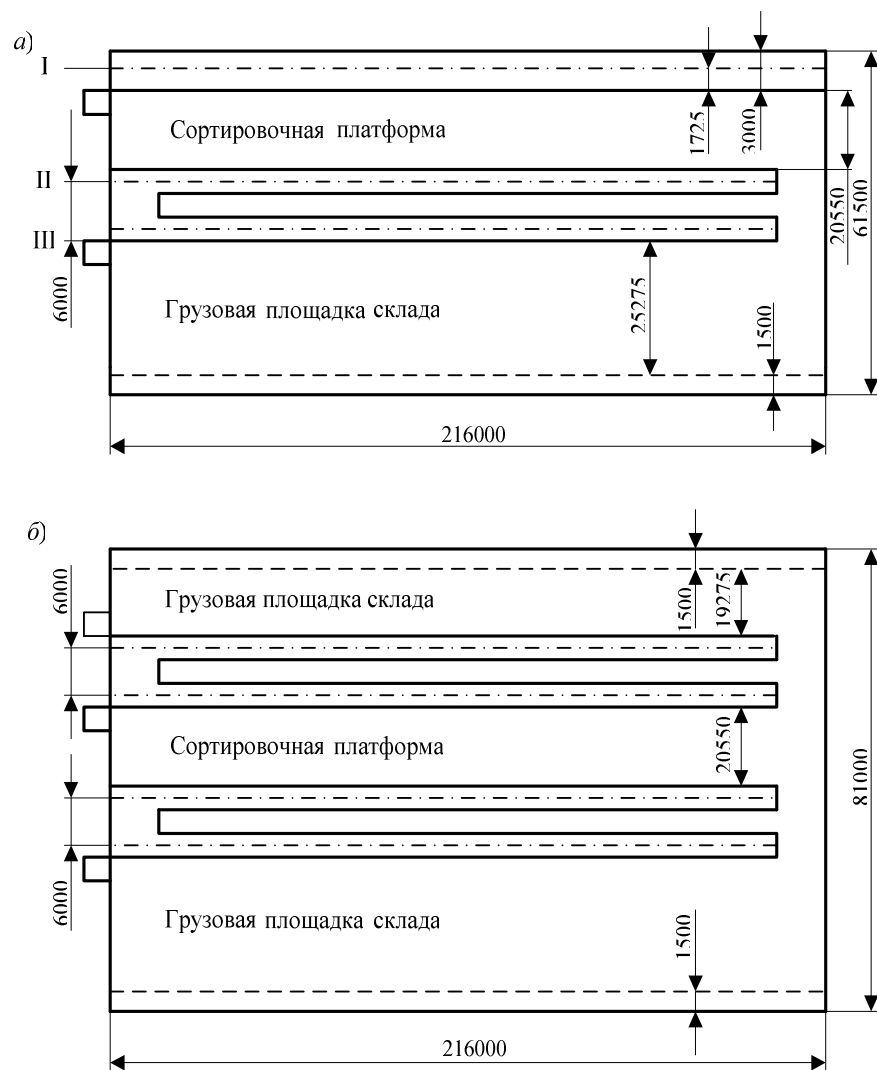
План двух- и трехпролетного ангарных складов
